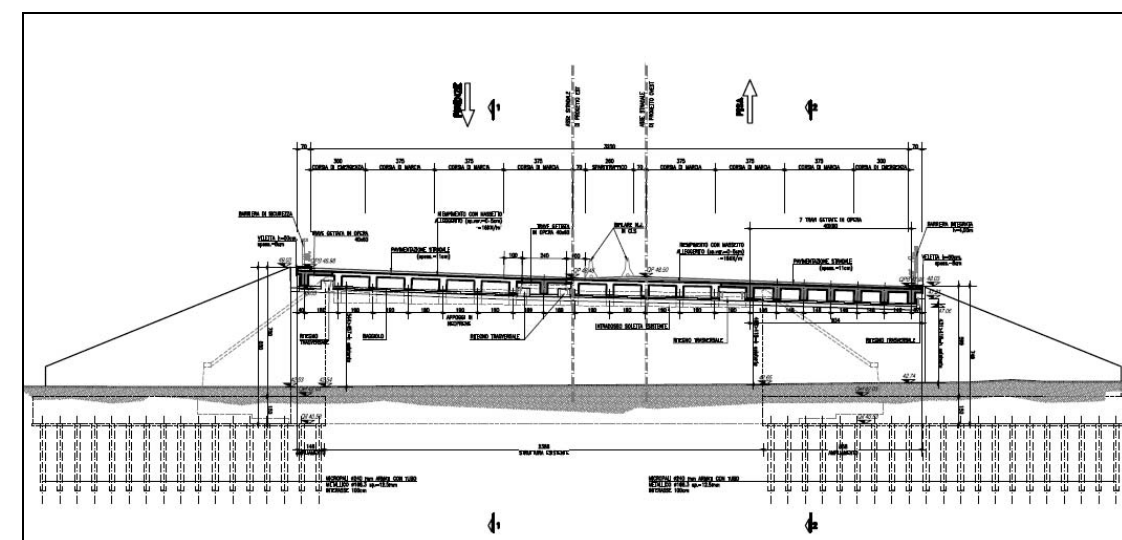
Sottovia di via del Ferro. Sezione trasversale
